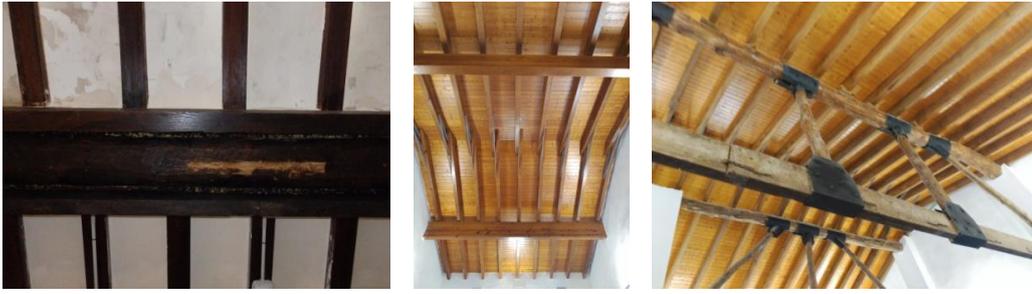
Planta baja, segundo distribuidor; Estructura de cubierta Aula Natura; Cerchas, sala de cerchas.
